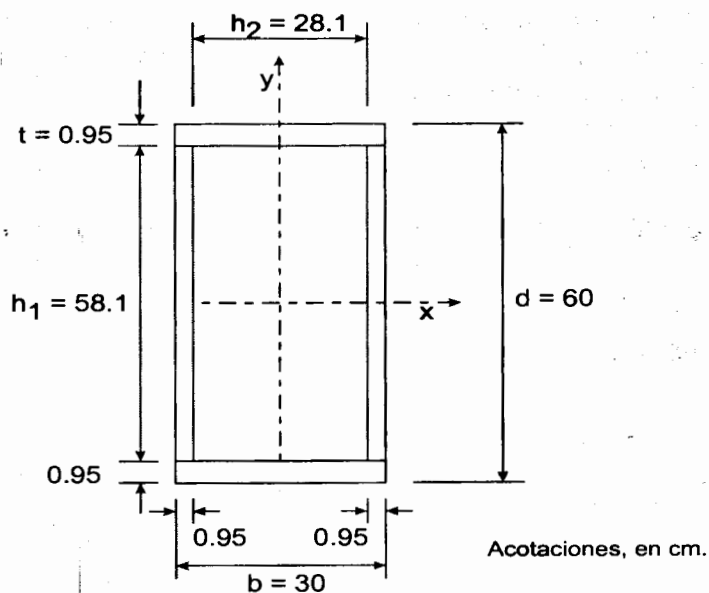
Sección transversal de la columna del ejemplo 2.5.
